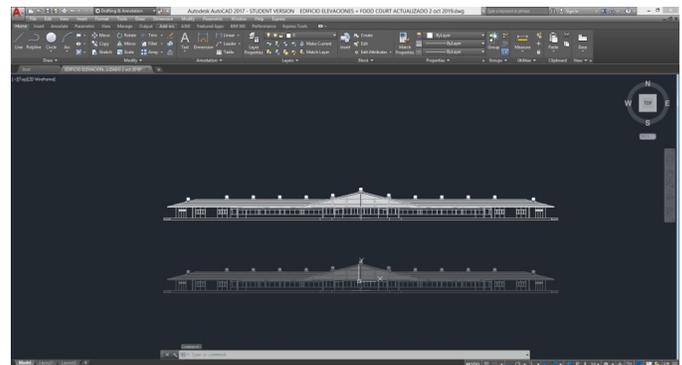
Vista 2D AutoCAD - Edificio Tiangué
